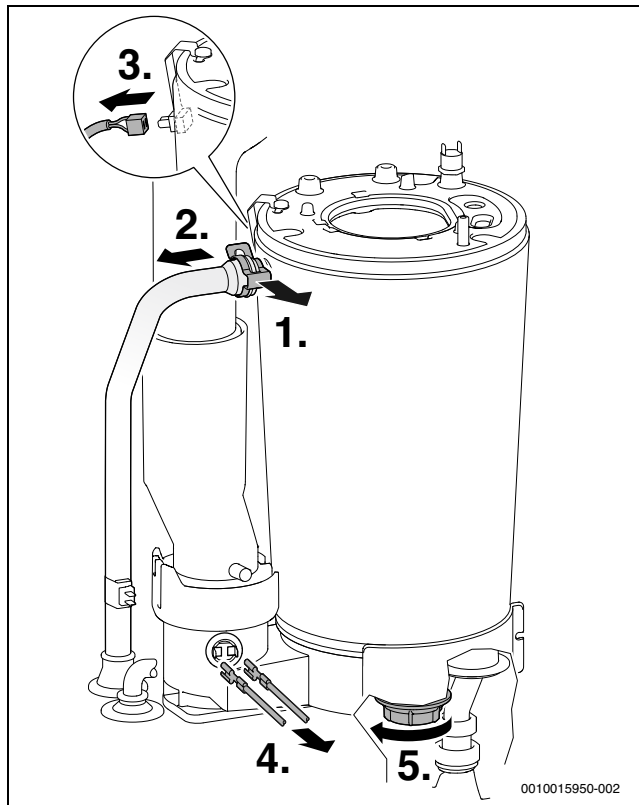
Soltar o tubo de avanço e retirar o cabo
